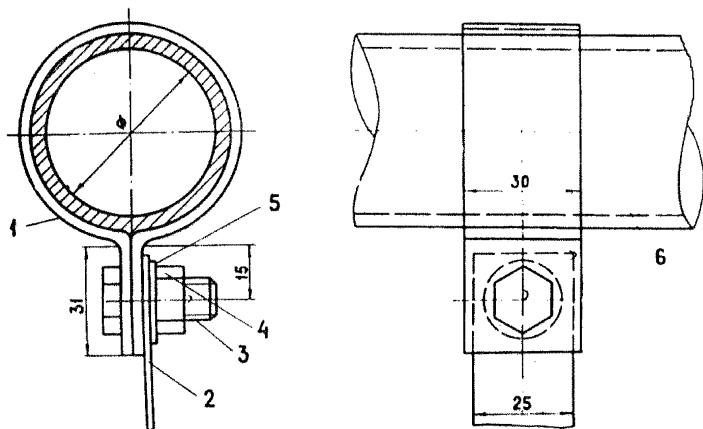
Схема присоединения заземляющего проводника к трубопроводу с помощью хомута:
